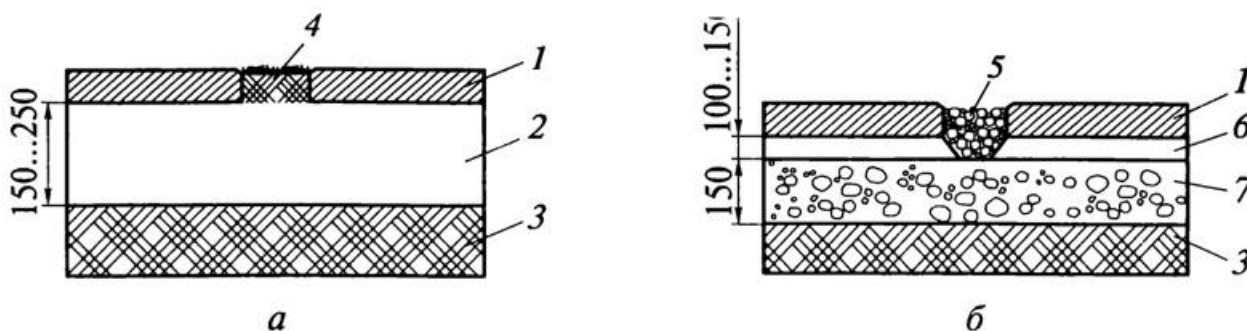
Типовые конструкции комбинированных покрытий: а – плитка на газоне; б – плитка с засыпкой швов щебнем; 1 – бетонные плиты или другое мощение; 2 – песок (толщина слоя зависит от типа грунта); 3 – подготовленное грунтовое основание; 4 – земля, засеянная семенами газонных трав, устойчивых к вытаптыванию; 5 – мелкий щебень (фракция – 6 мм); 6 – песчаная подушка под плиты; 7 – щебень
